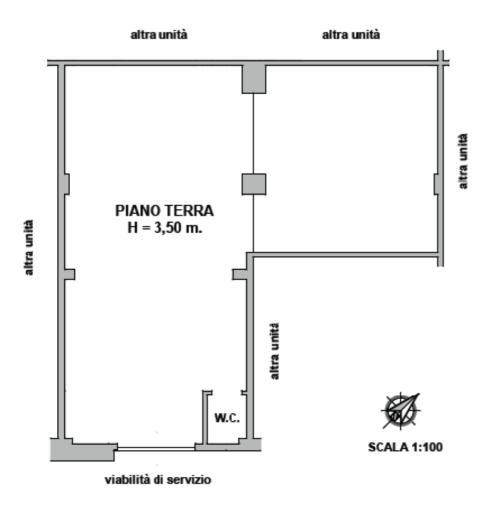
LOTTO 6 - Planimetria laboratorio artigianale foglio 76 - part. 620 - sub. 69
